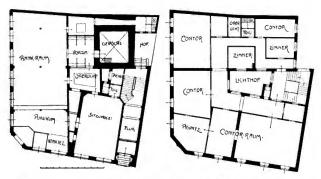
und 376. Grundrifs der beiden Hauptgeschosse des Bankhauses B. Loose & Co. K. Bollmann. 1890.
